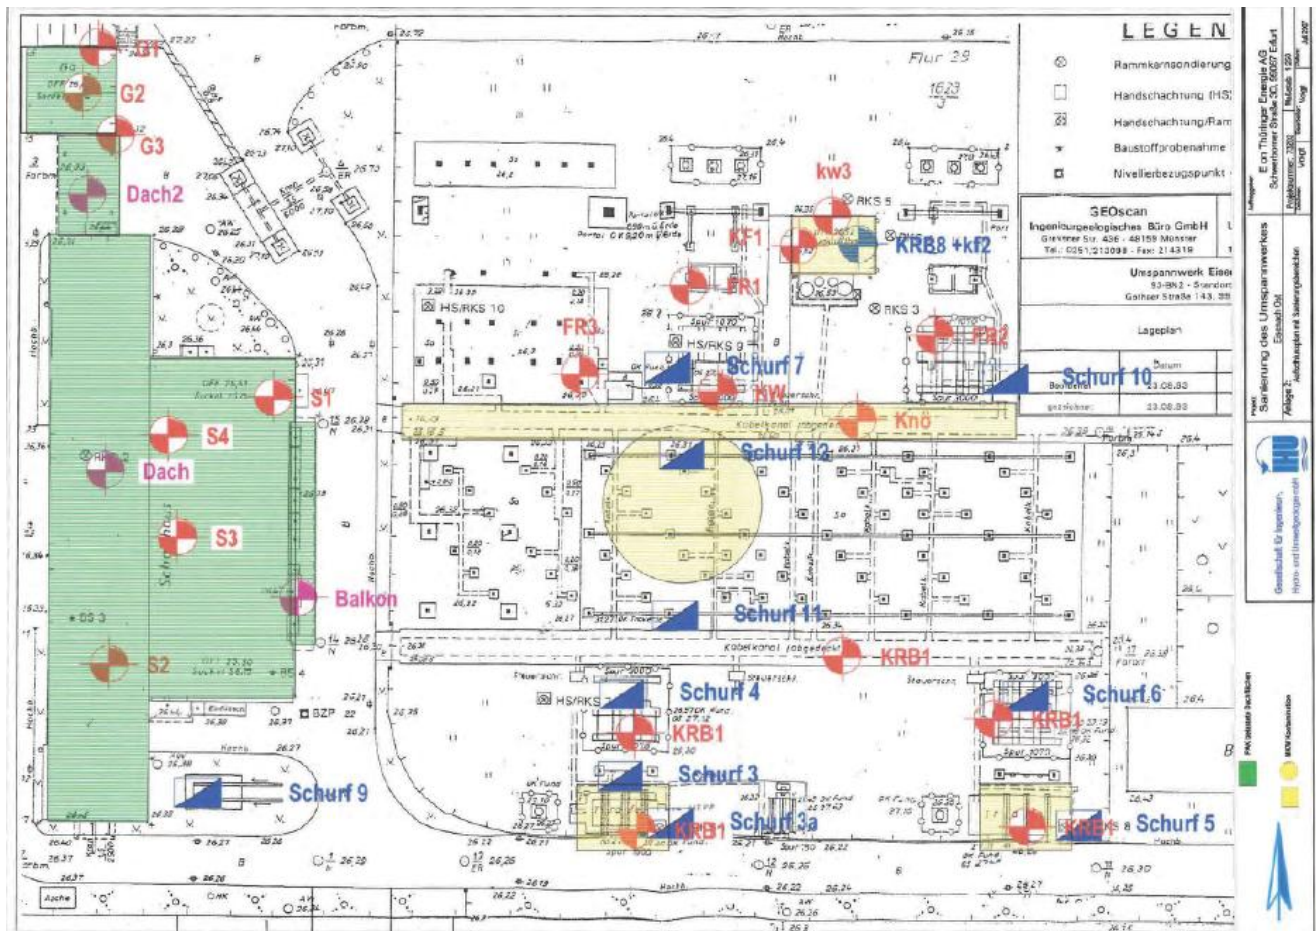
Aufschlussplan mit (vorgeschlagenen) Sanierungsbereichen (gelb) (lt. Anl. 2 aus [2])
